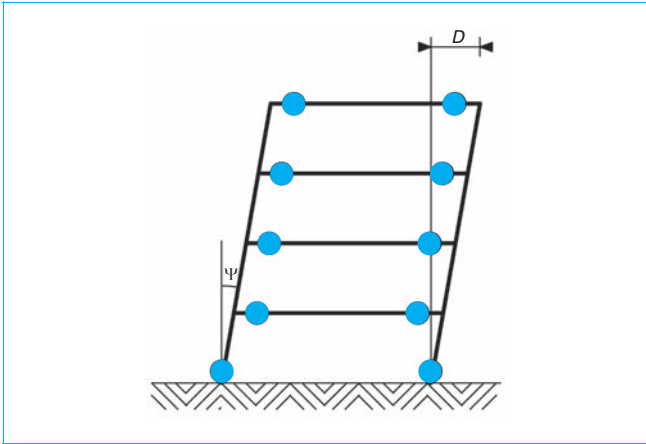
Mécanisme « poutres faibles/poteaux forts »
